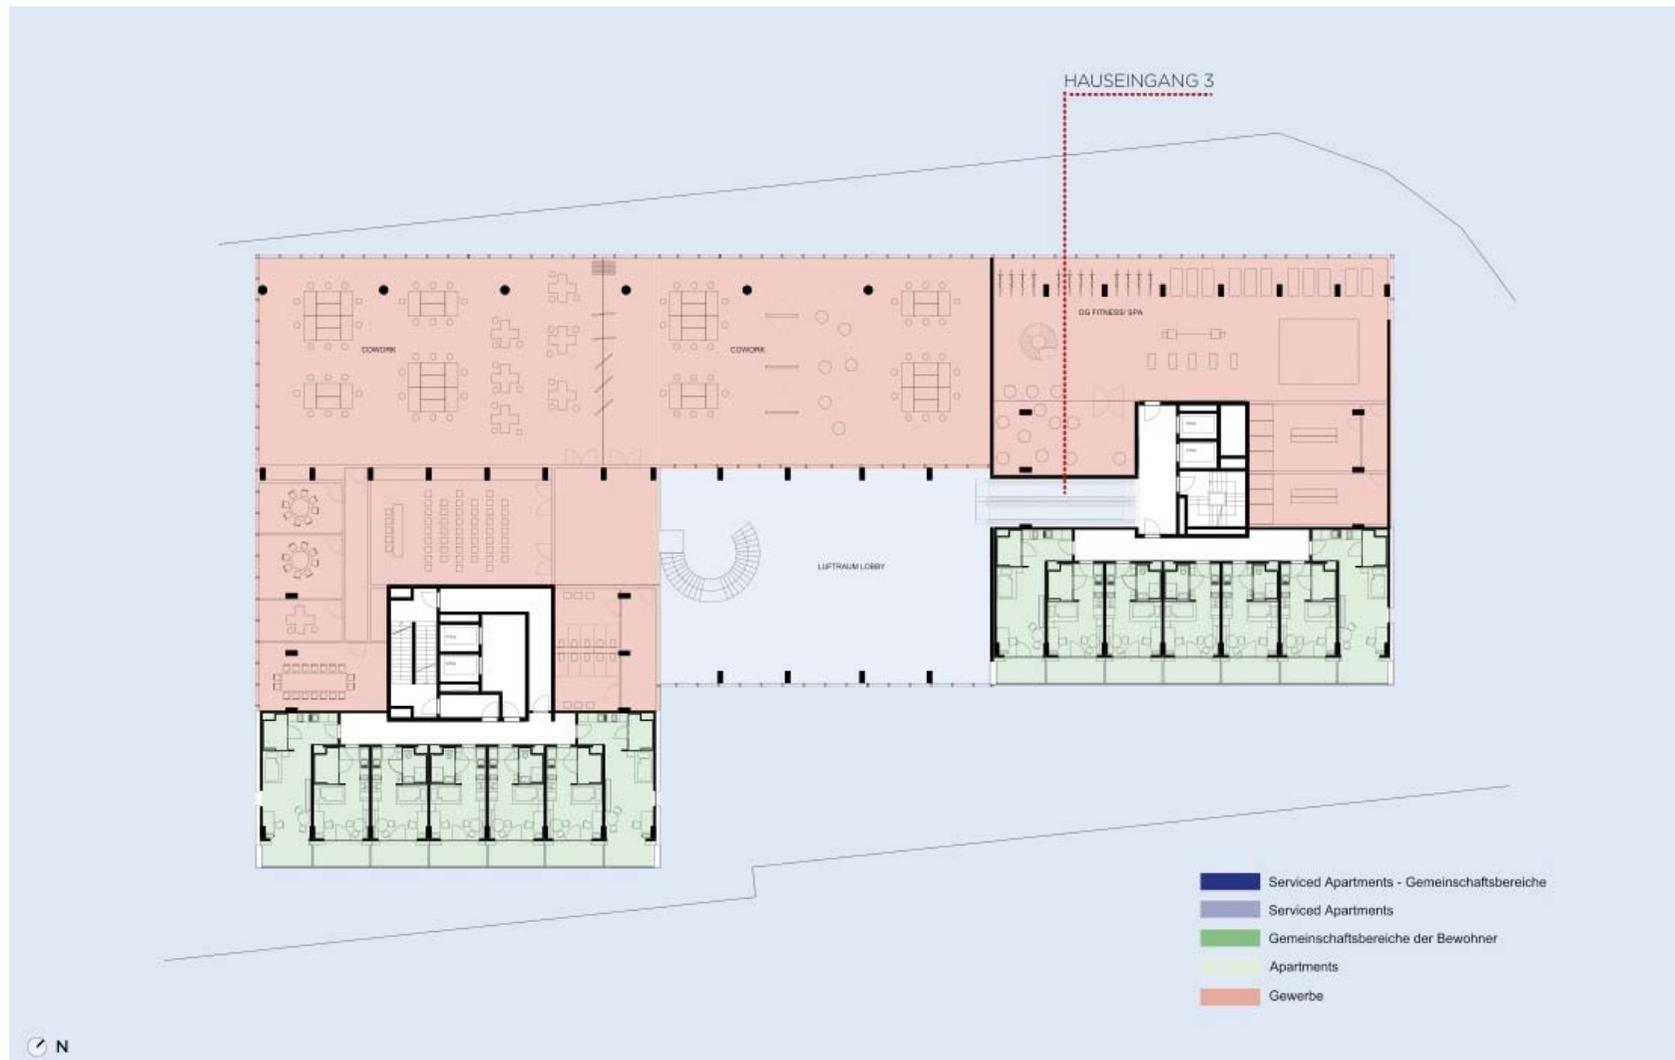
Raumprogramm – Grundriss 1. OG nach Weiterentwicklung (Sockelgeschoss)
